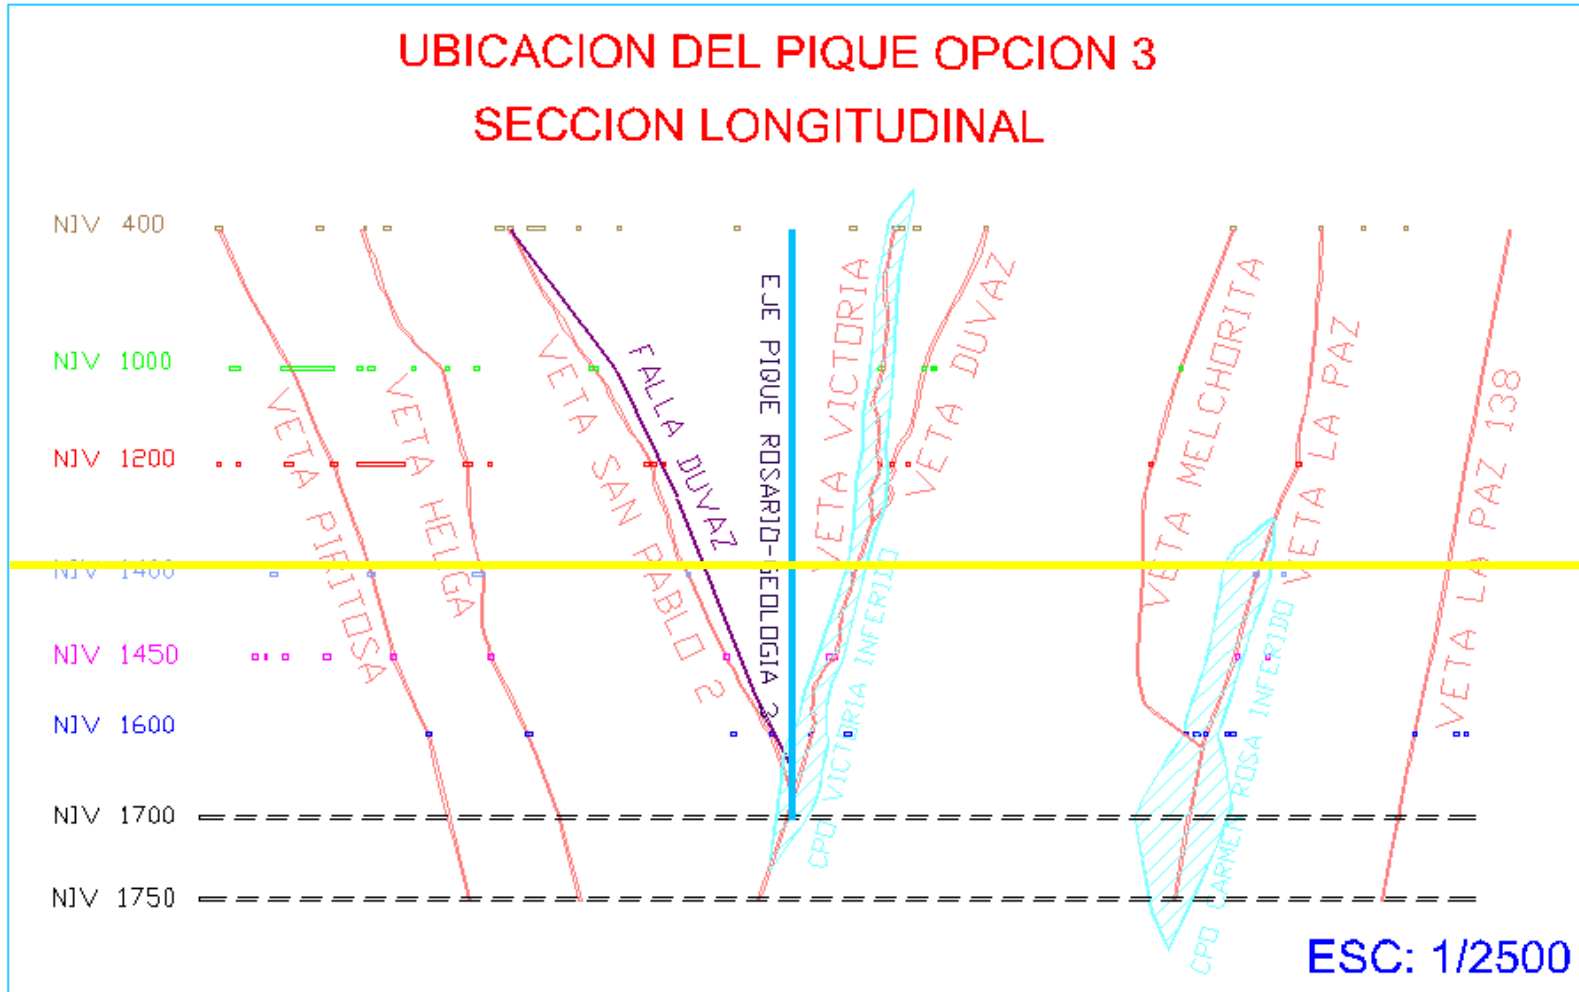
Plano de Ubicación de Pique Central – Opción 3
